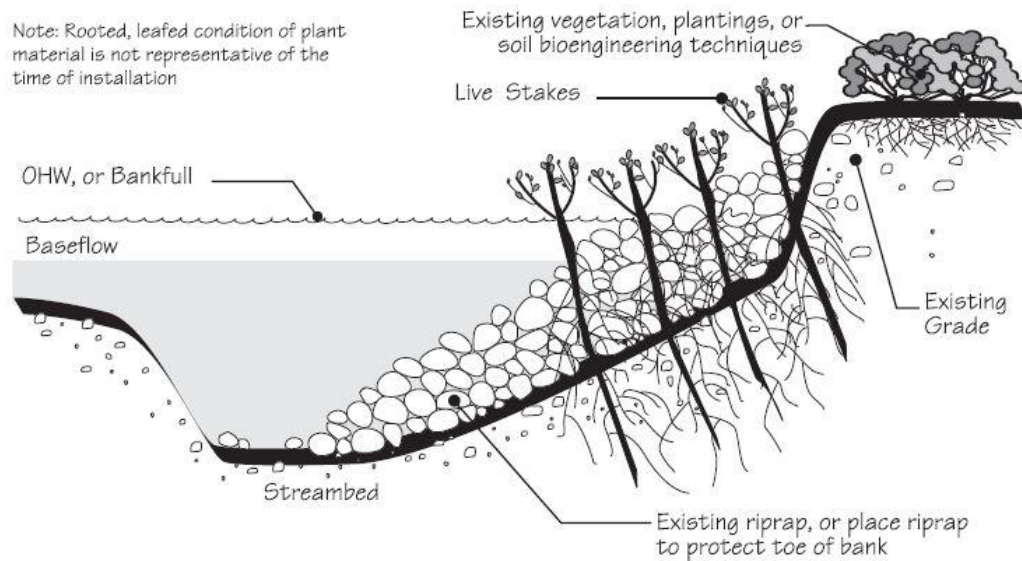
Siembra conjunta (Joint Planting) (Fuente: USDA, 2000)
